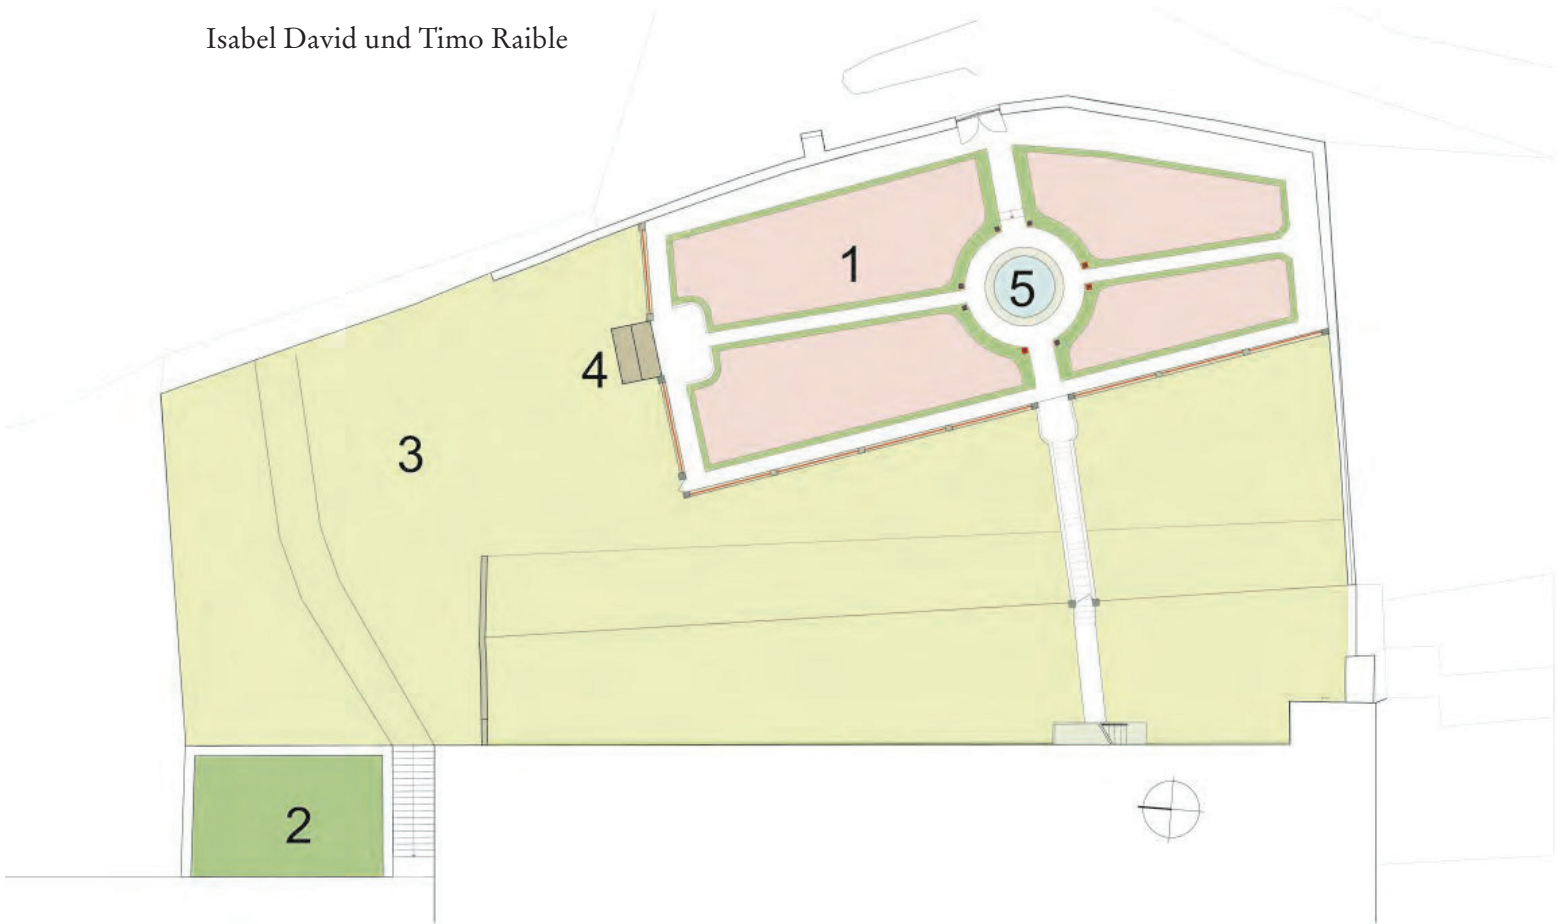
Zeichnerischer Rekonstruktionsversuch des Barockgartens. (1) Blumen- und Kräutergarten, (2) Küchengarten, (3) Baumgarten, (4) Gartenpavillon, (5) Springbrunnen (Lageplan: Isabel David 2018).
